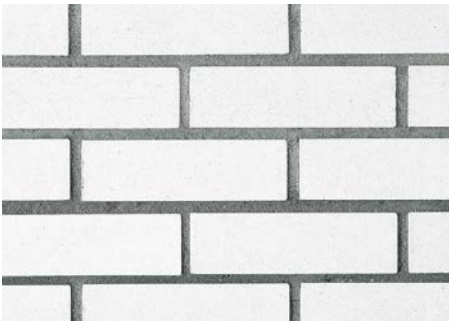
Bei KS-Verblendmauerwerk mit ca. 1 cm dicken Stoß- und Lagerfugen handelt es sich um eine Bauweise mit Fuge.
